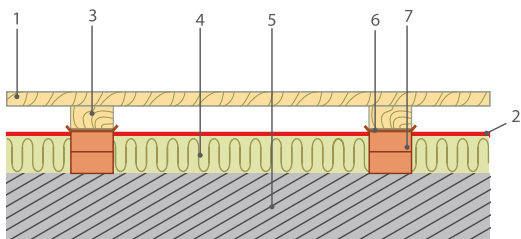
Утепление плитного перекрытия с лагами по столбикам:
